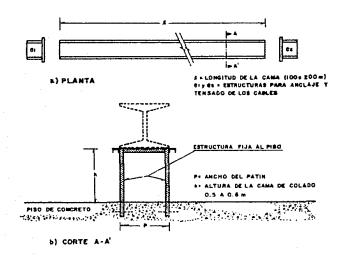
a,b.- CAMA PARA TENSADO Y COLADO DE PILOTES PRESFORZADOS
